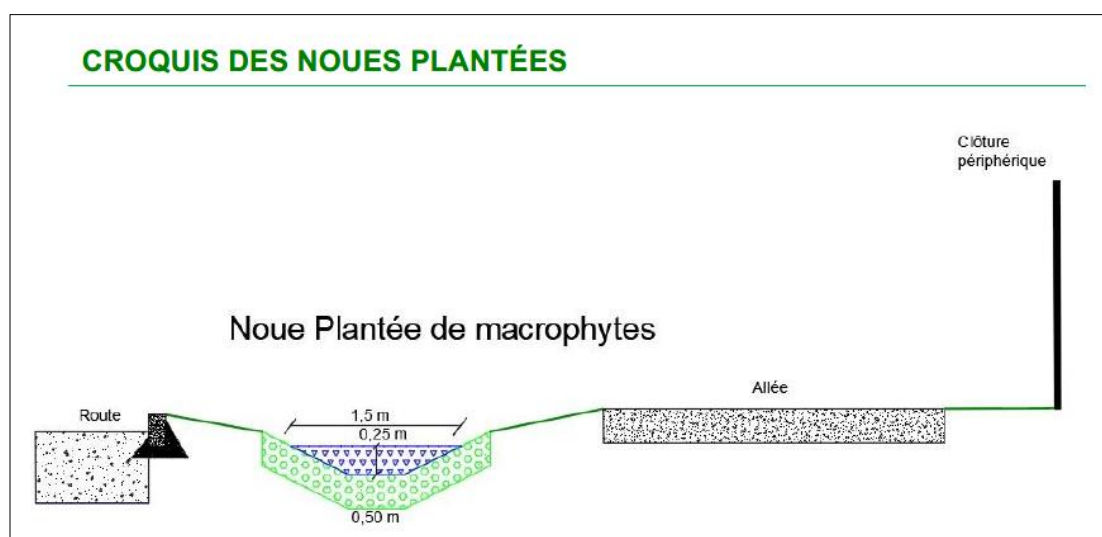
Croquis de la noue plantée (Source : CECOTECH Ingénierie)
